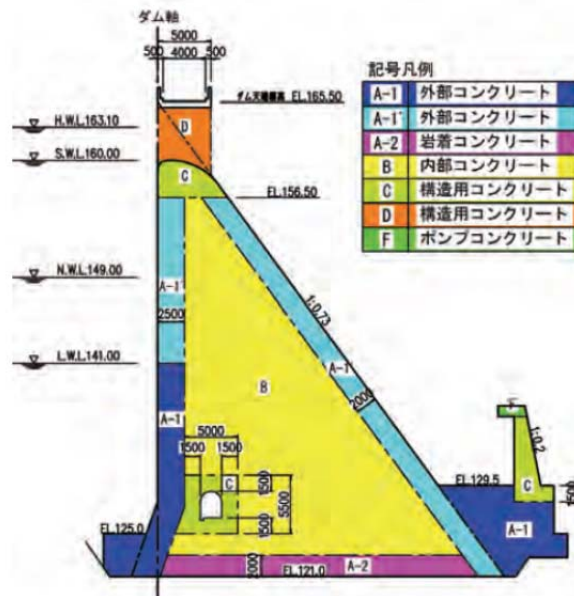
図-16 堤体コンクリートの配合区分図 (越流部標準断面)
